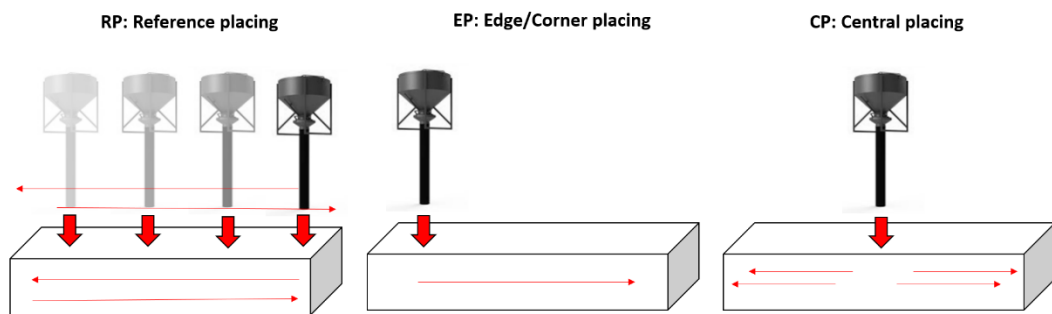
Condiciones de vertido en elementos horizontales - vigas
